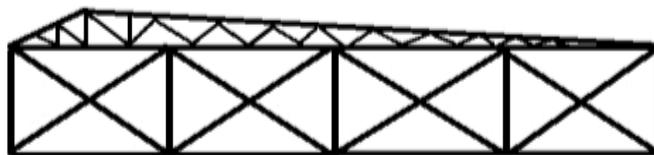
Метало-конструкционное соединение стен и крыши вид сбоку
